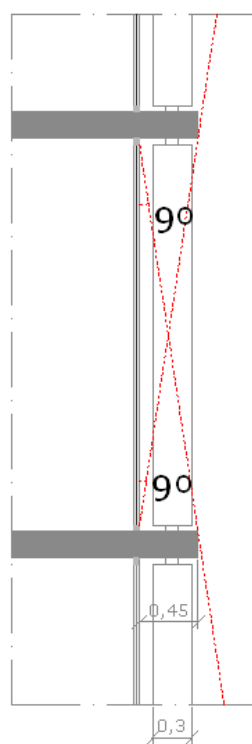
Corte esquemático e prolongamento da laje como protetor horizontal.
